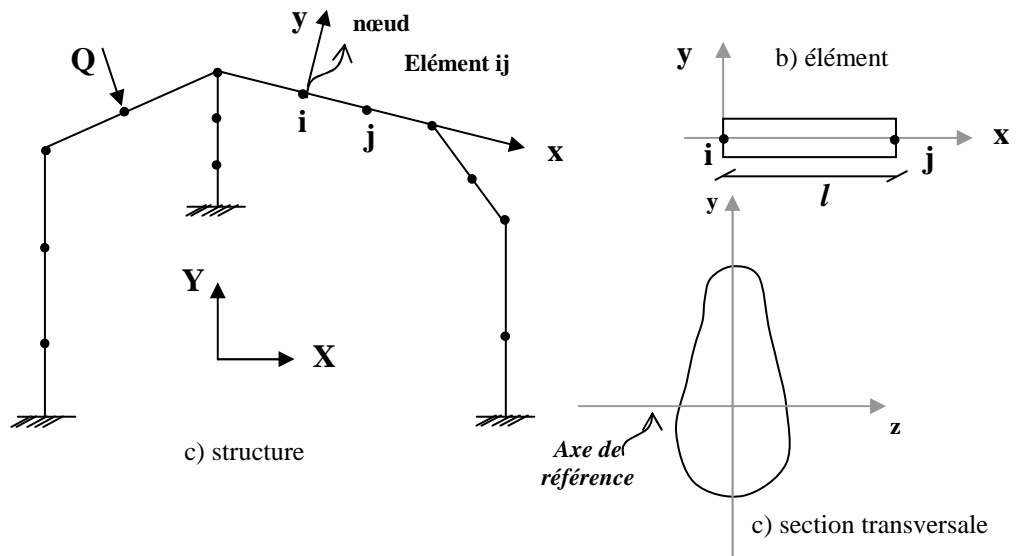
Schématisation d'une ossature en poteaux-poutres
